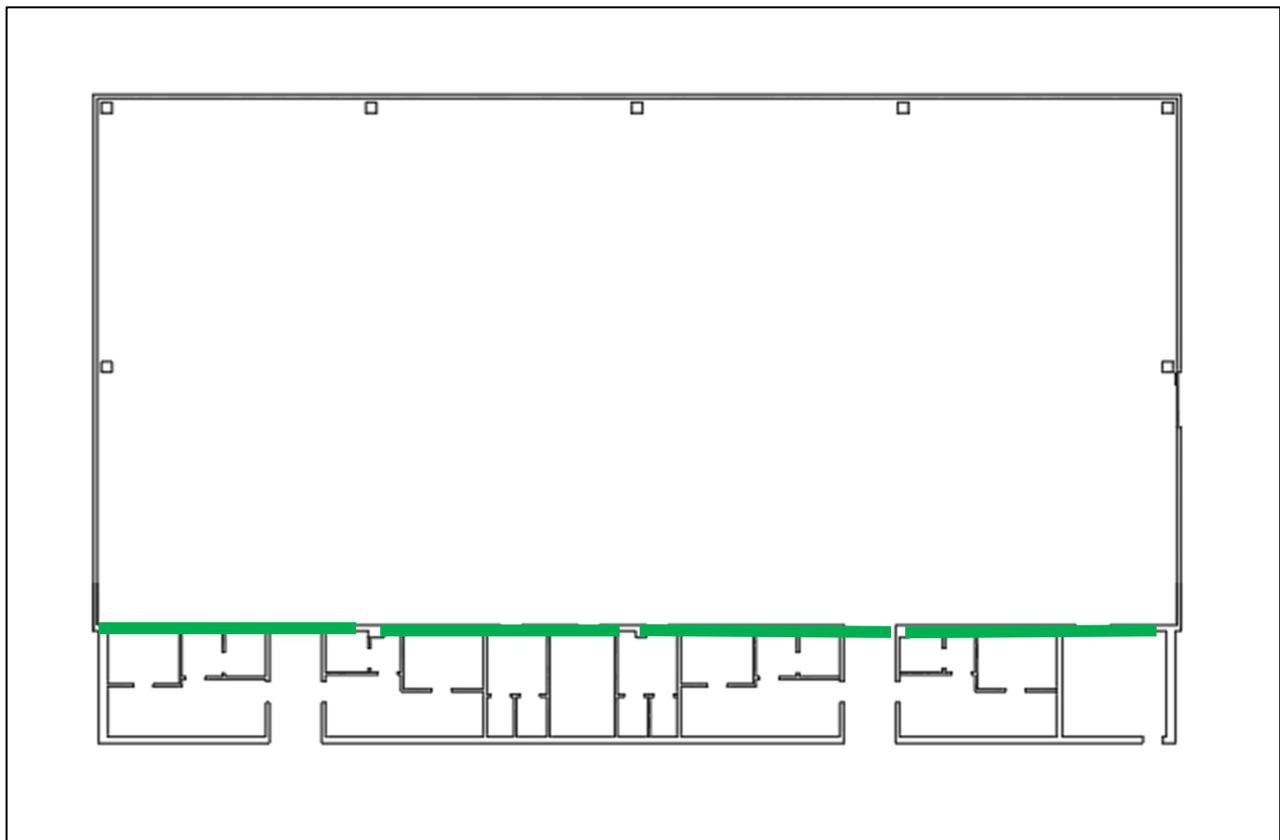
Pianta dell'edificio – Stato attuale con individuazione delle murature in blocchi di cls
